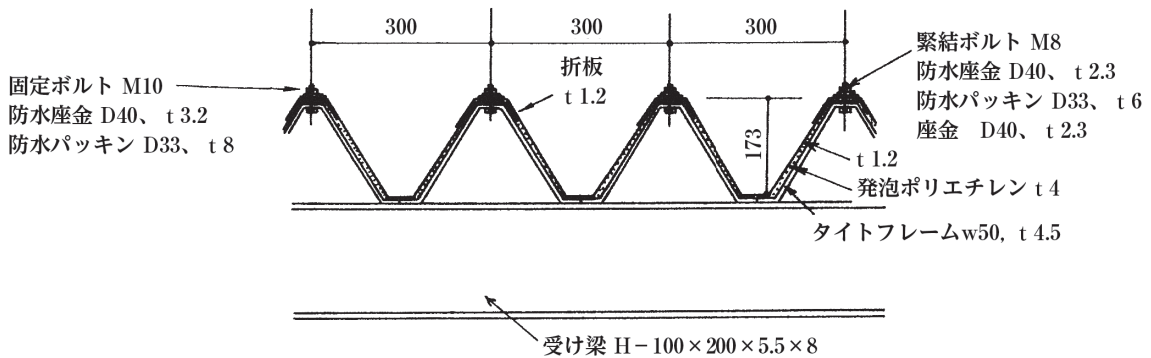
屋根一般部分及びタイトフレームの取り付け方 縮尺 1/5 & 1/2
